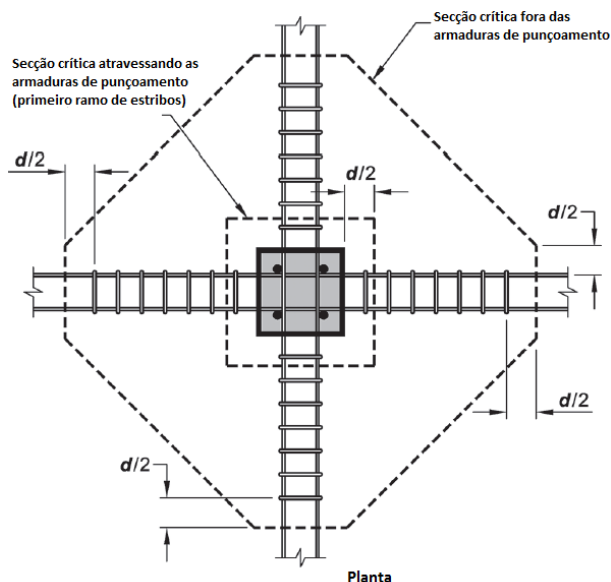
Secções críticas de controlo de punçoamento para pilares interiores com armaduras de punçoamento (Adaptado de ACI 318-14, 2014)
